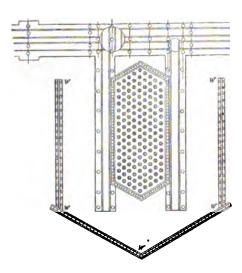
Grundriss der Transportbrücke und Pfahlwände.
